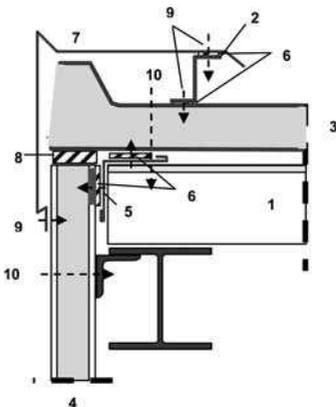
Ortgangausbildung bei Deckungen mit Sandwichelementen
